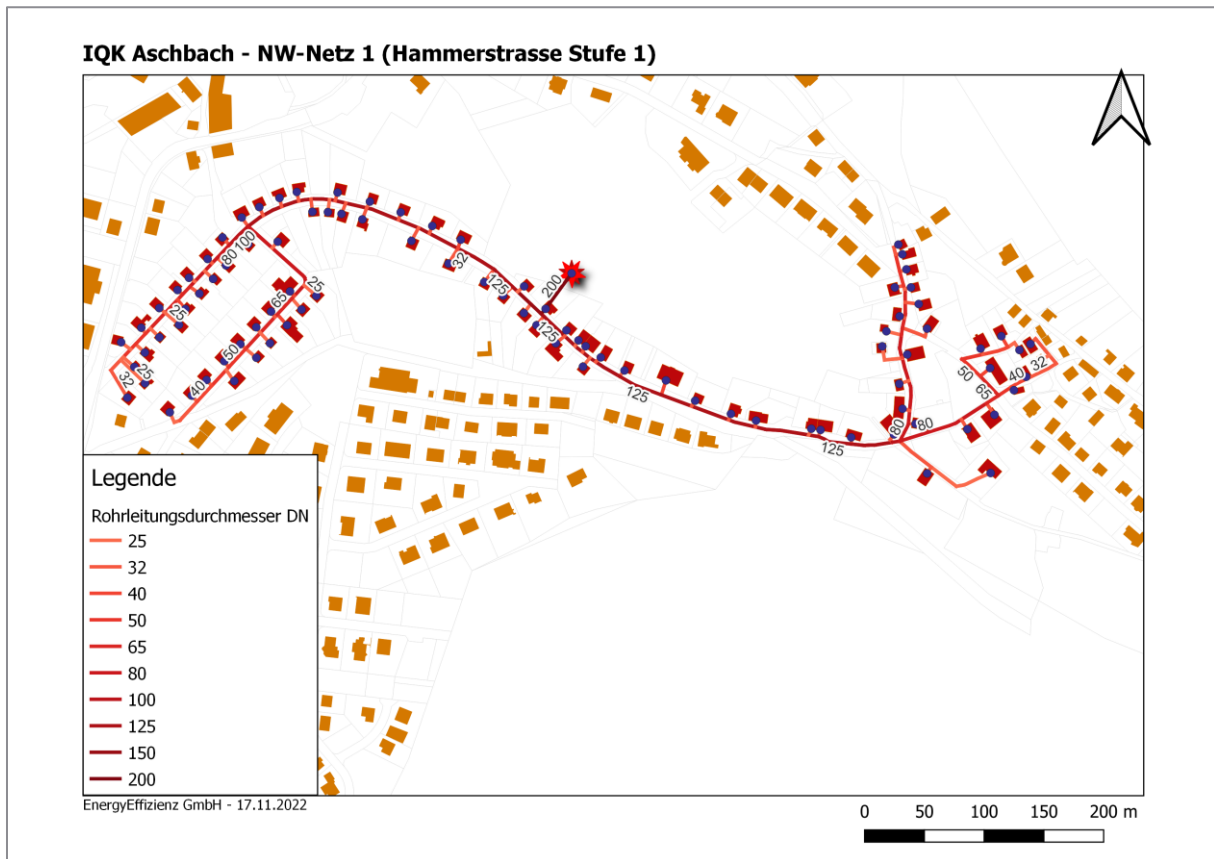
Nahwärmenetz 1, Hammerstraße Stufe 1
